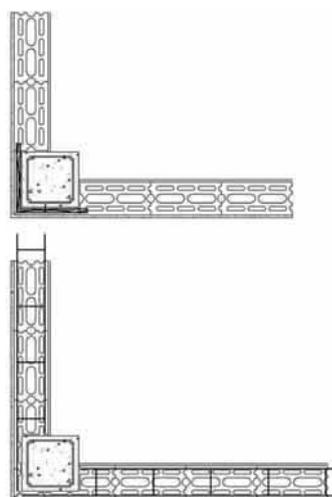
Planta de encuentros de muro de 1 hoja multicámara de cerramiento con pilares en esquina: hiladas pares con anclajes, hiladas impares con retículas de tendel.
